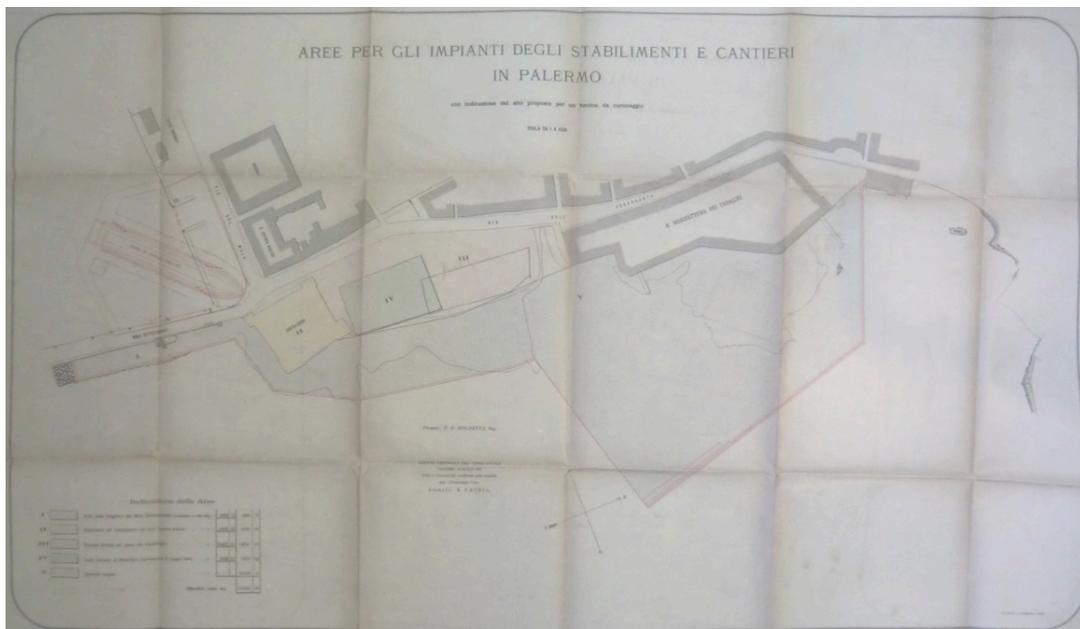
Planimetria generale delle aree in concessione. Allegato alla concessione del 16 marzo 1897. ASCPa, fondo LL.PP. Serie 954 1897
